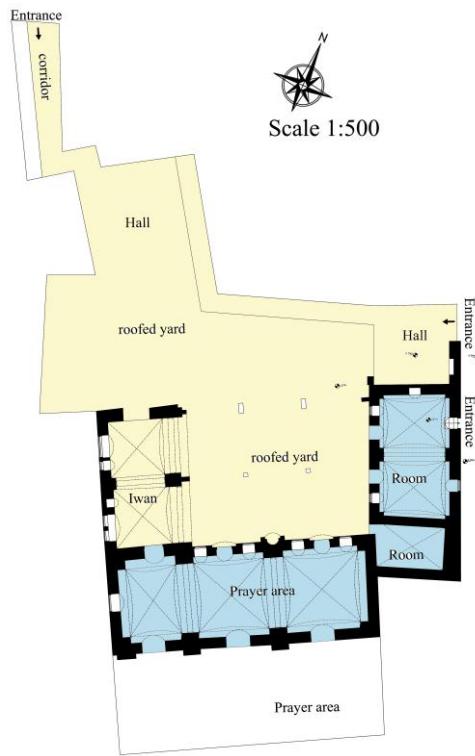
مسقط أفقي مسجد على بن مروان (وزارة السياحة والآثار، 2013م)
